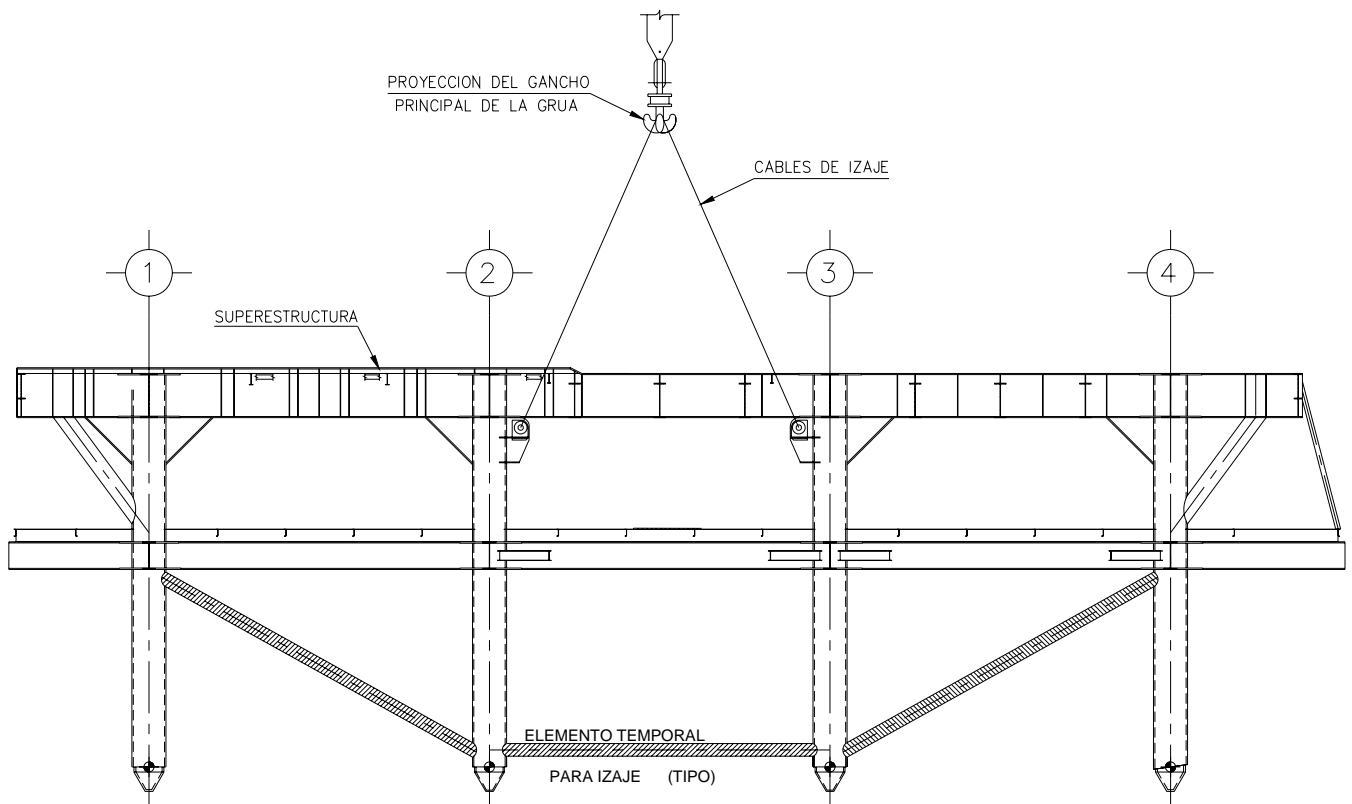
ARREGLO DE ELEMENTOS DE REFUERZO TEMPORAL PARA EL IZAJE Y TRASLADO
